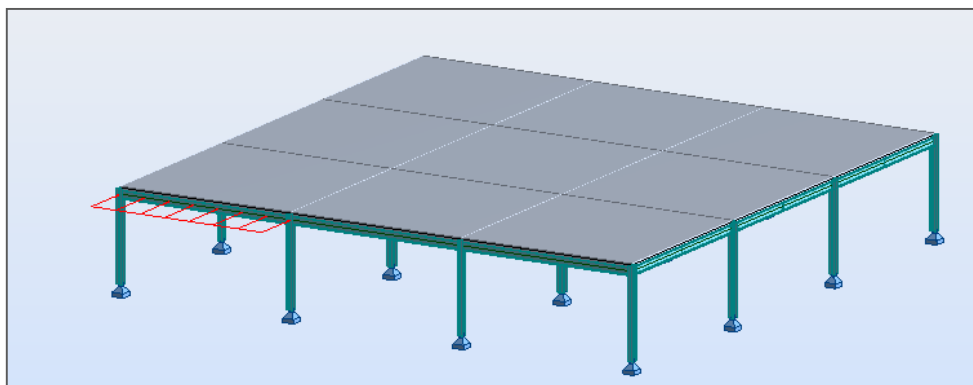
Modelo II: determinação da rigidez axial da laje mista.
